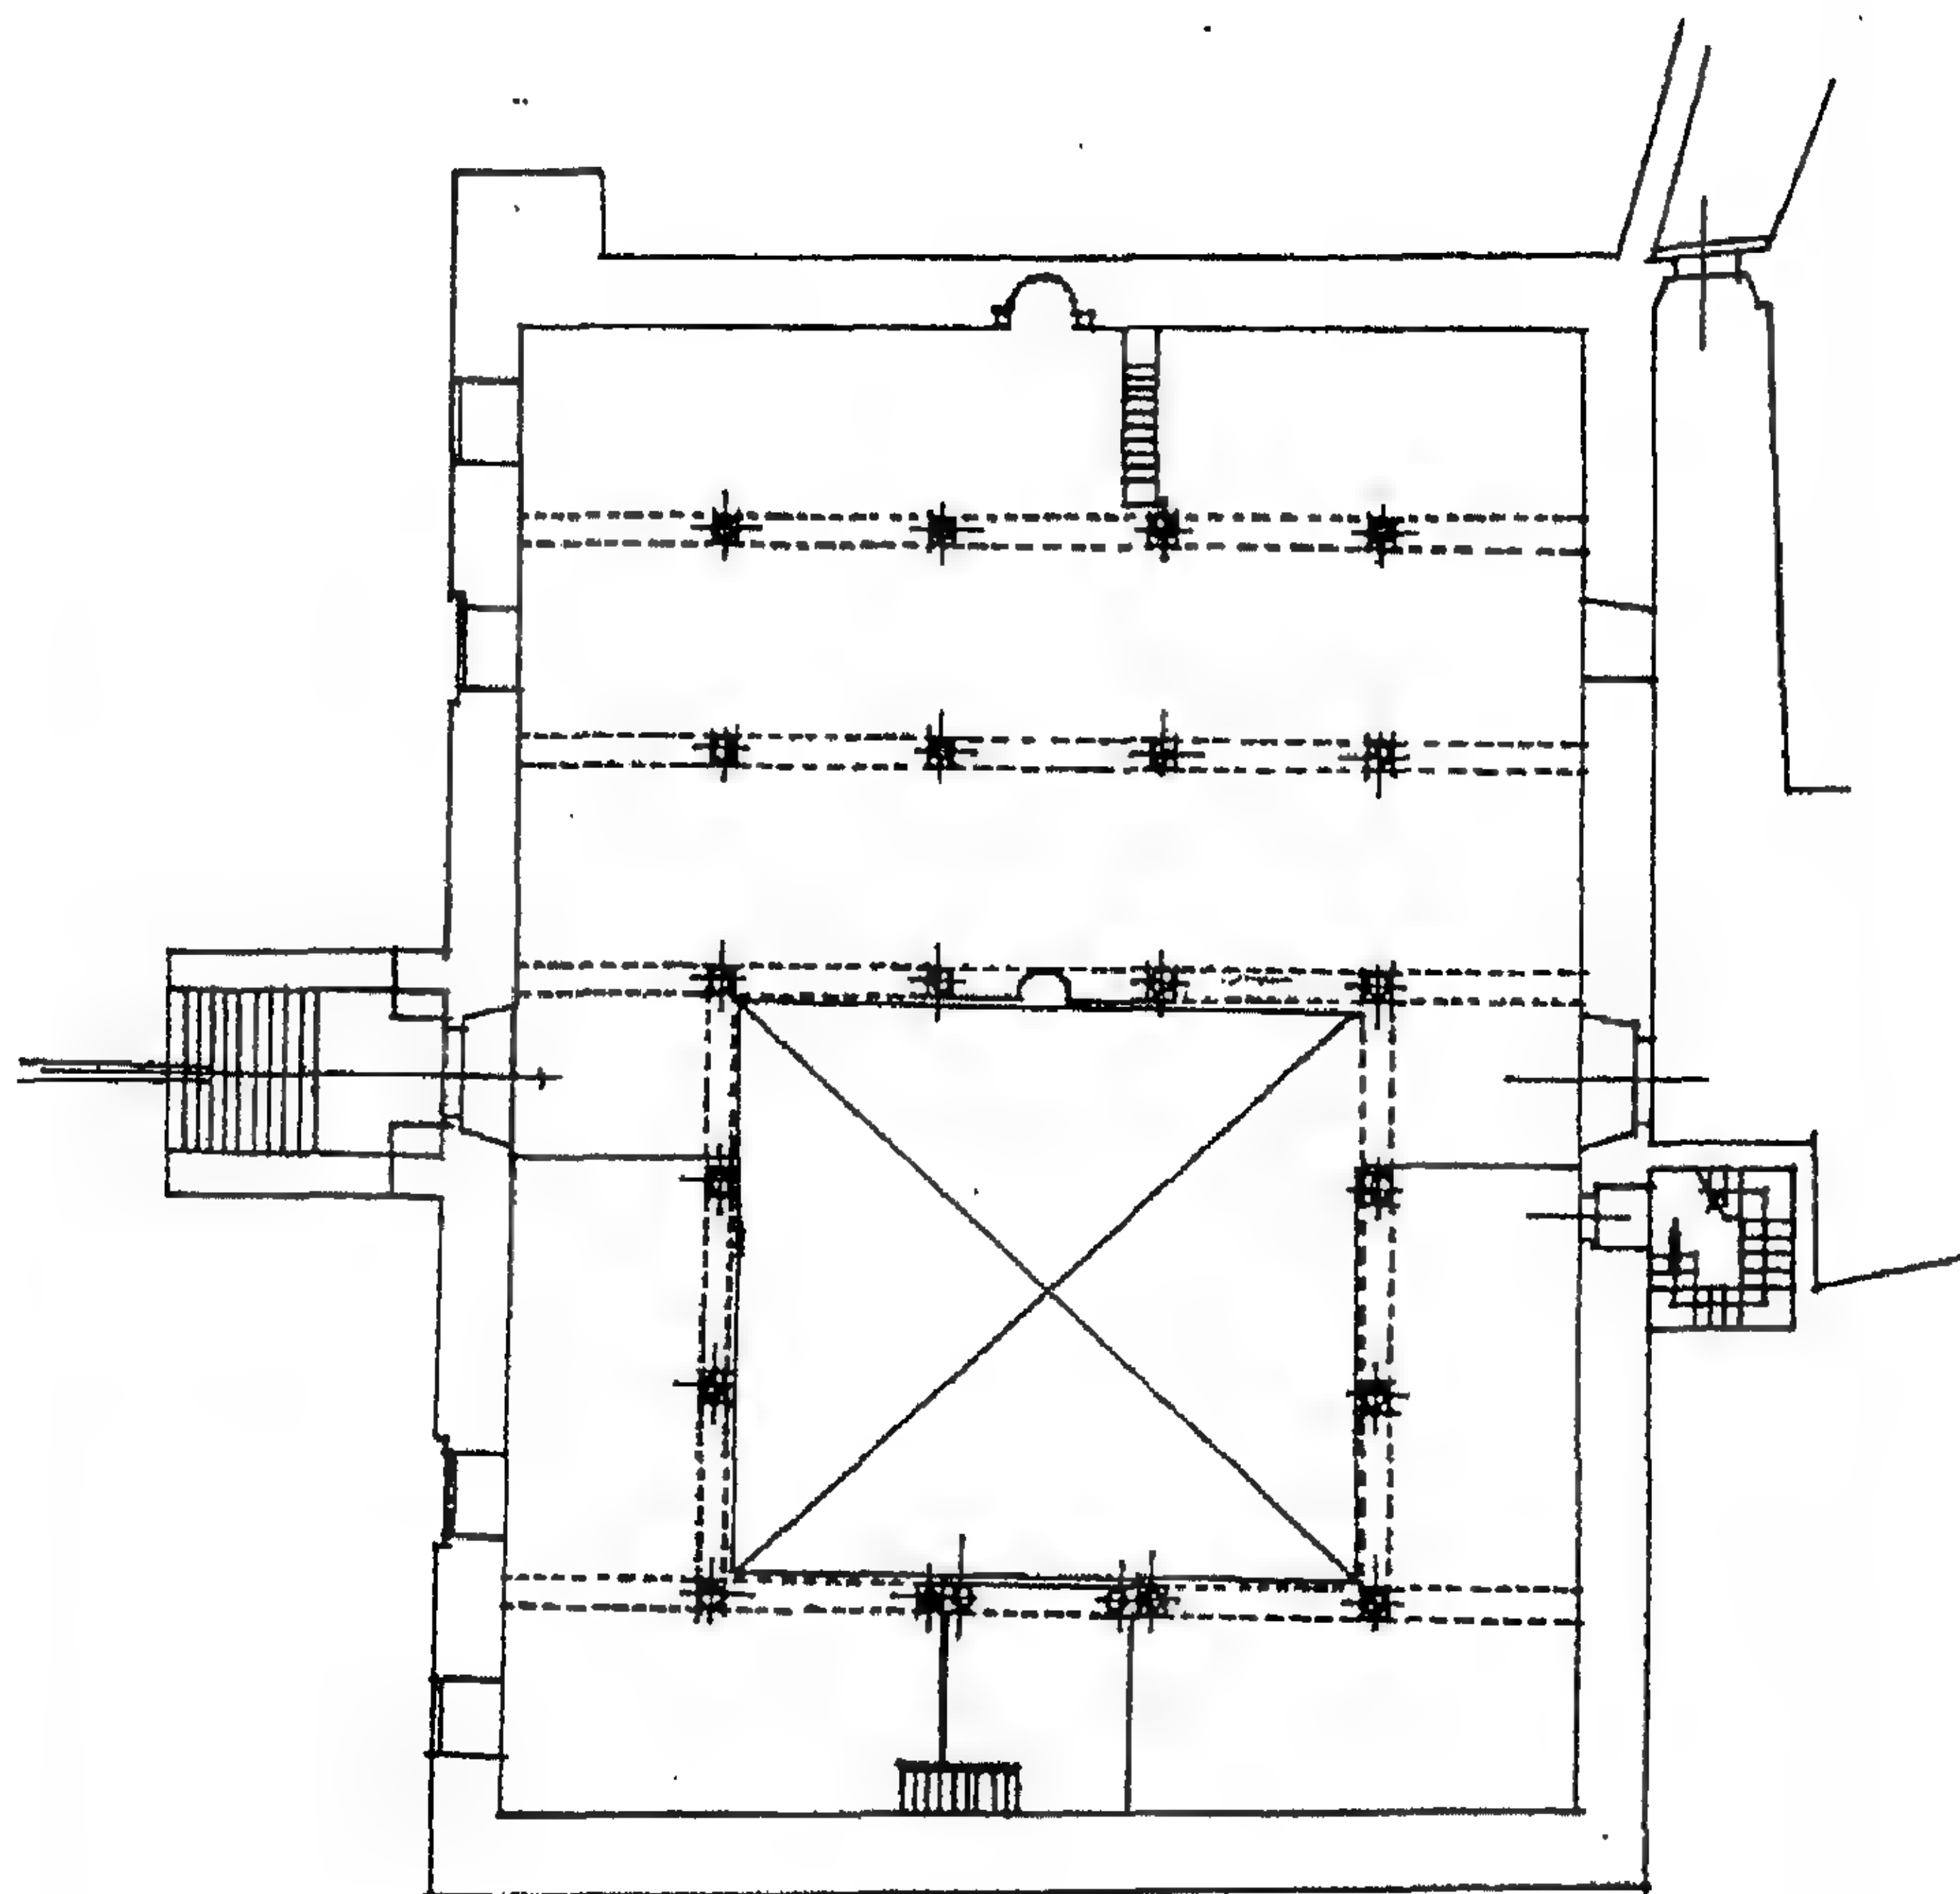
مسقط أفقى لزاوية رضوان بك الفقارى بالقريبة.
